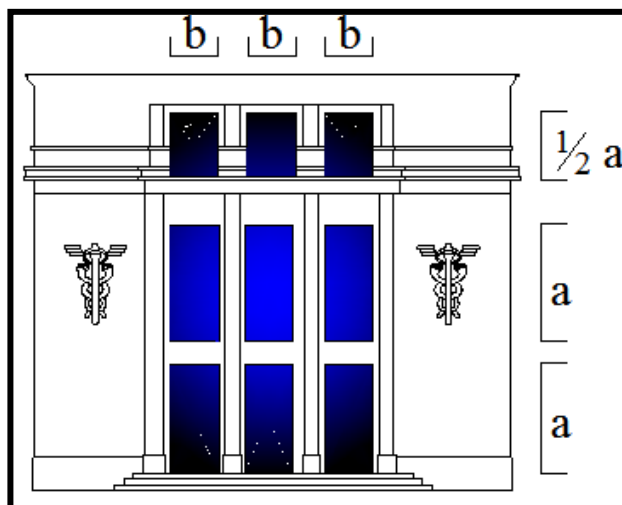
Les dimensions d'ouverture de la façade du palais consulaire
